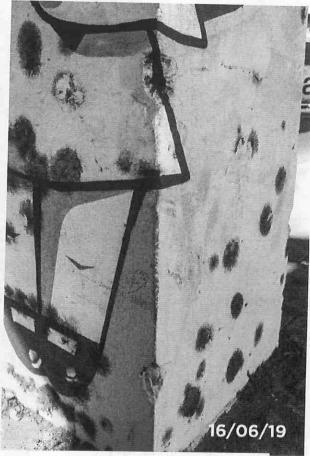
Detalhe segregação do concreto, trincas, desplacamento do concreto do pilar, pontos aparentes de bolor, devido a infiltração de água no concreto
